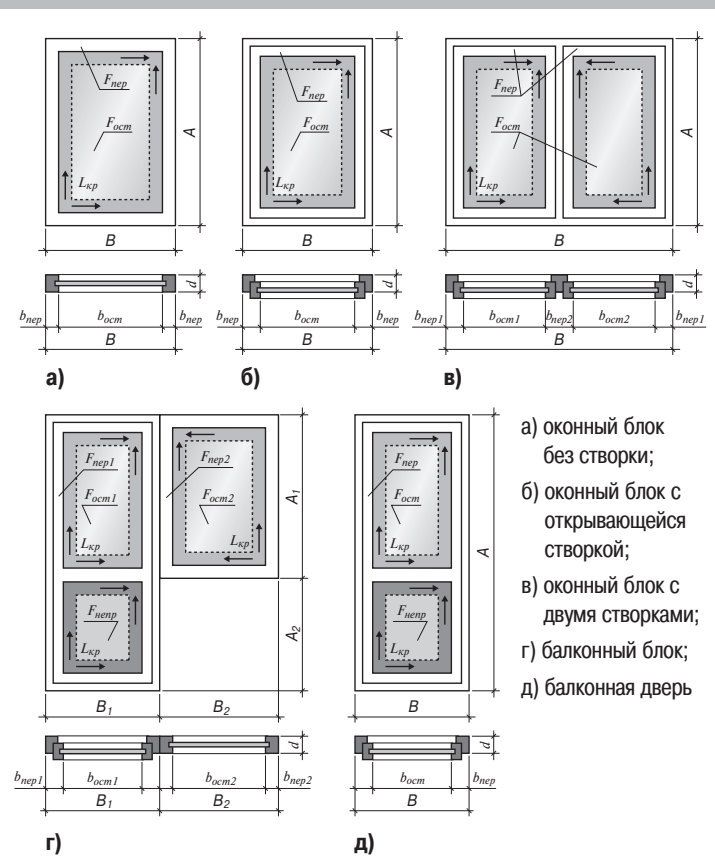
Расчетные схемы для определения площадей остекления, переплетов и размеров краевых зон оконных и дверных балконных блоков различного конструктивного решения
